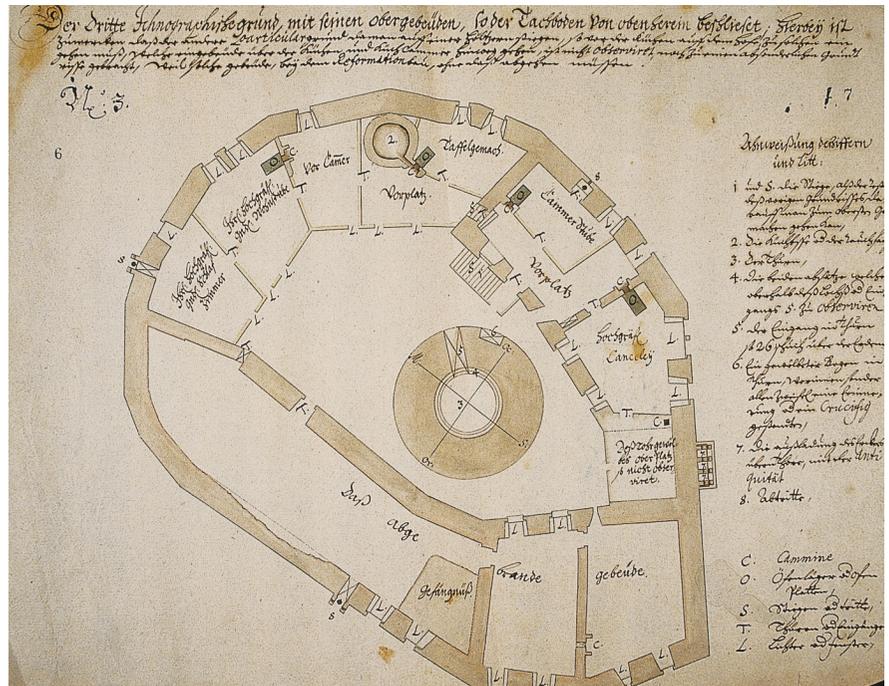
Dritter Grundriss (Obergeschoss) des durch den Brand vom 29. Nov. 1667 teilzerstörten Schlosses Blankenhain (undatiert, 1667-1669), HWA Abt. II, Nr. 6317.
